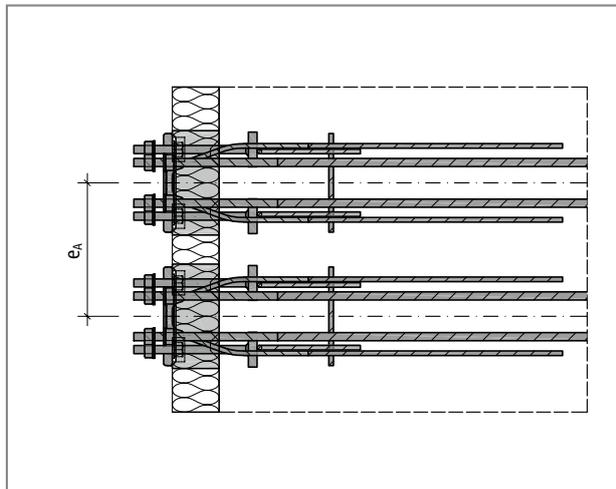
Schöck Isokorb® T Typ SK: Achsabstand
